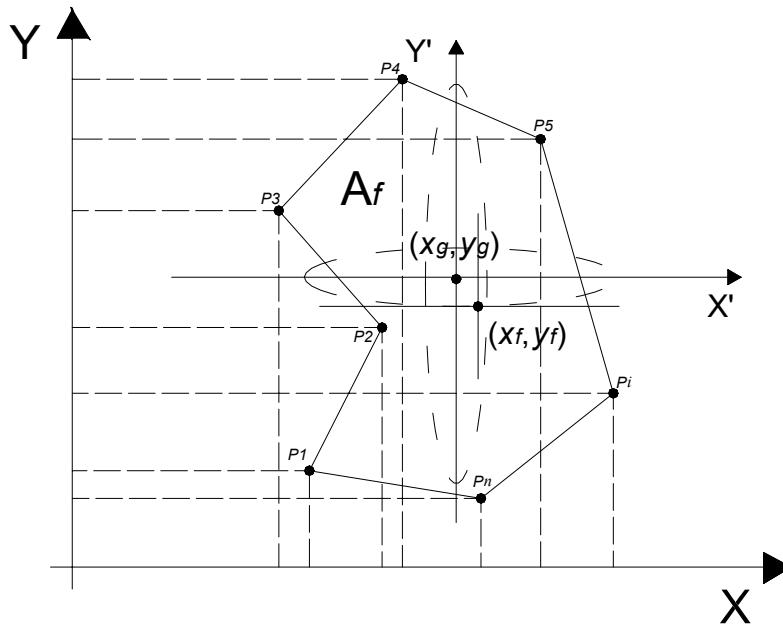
Forma general de un planta considerada para el cálculo del parámetro 6 (configuración en planta del edificio).
